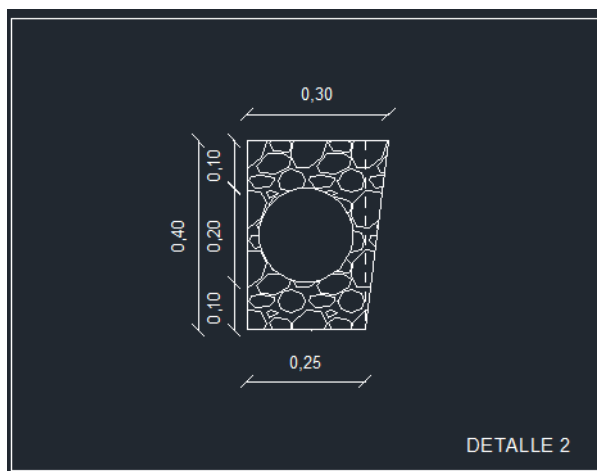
Detalle de la excavación manual para colocación de tubería
